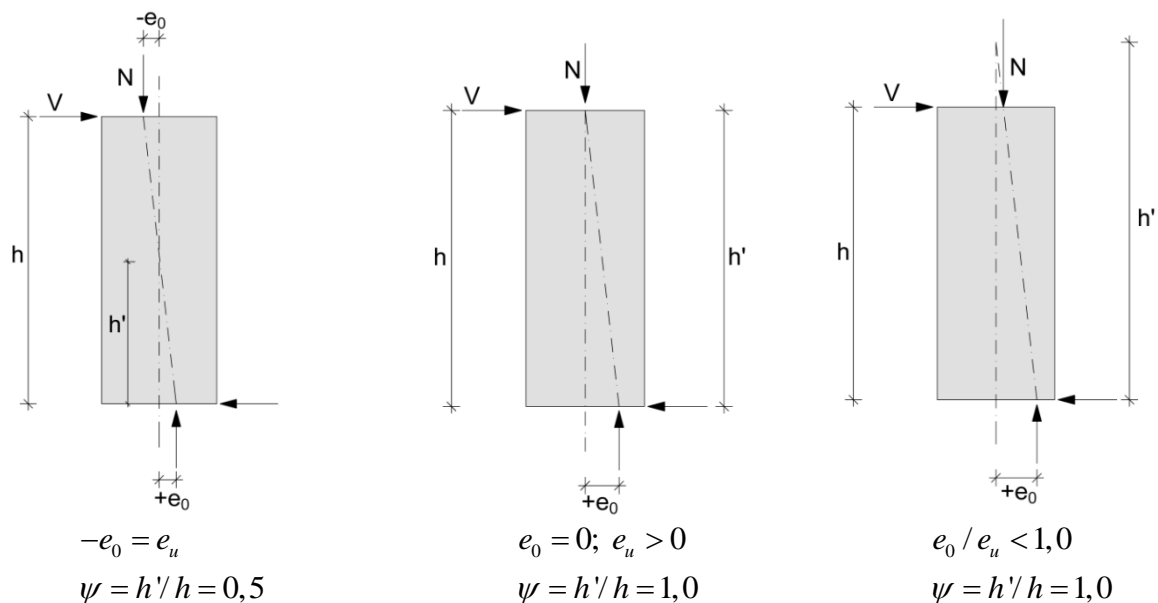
Beispiele für Lastausmittungen am Wandkopf und am Wandfuß einer Wandscheibe nach DIN EN 1996-1-1/NA
